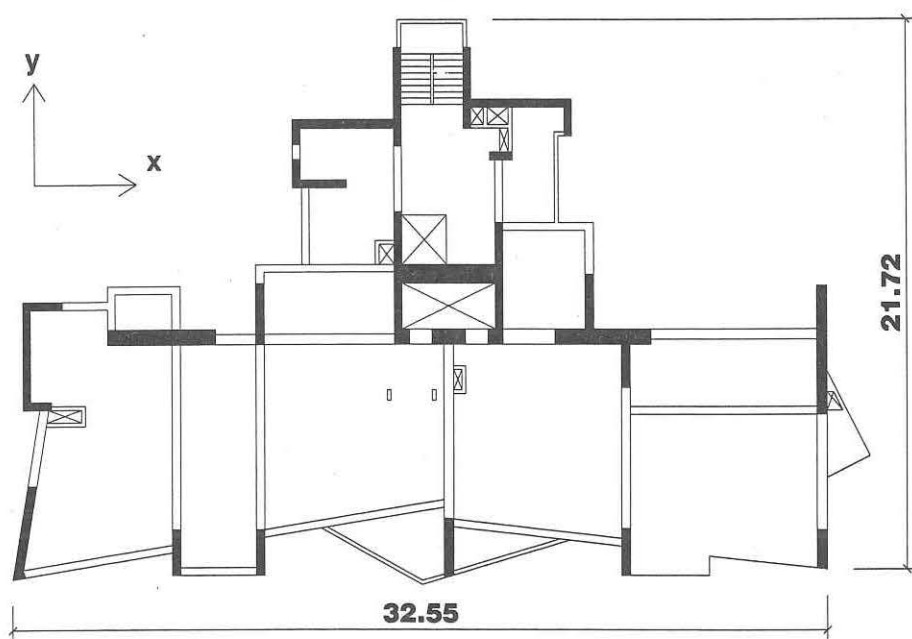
Planta típica de un edificio de concreto armado de 22 pisos
